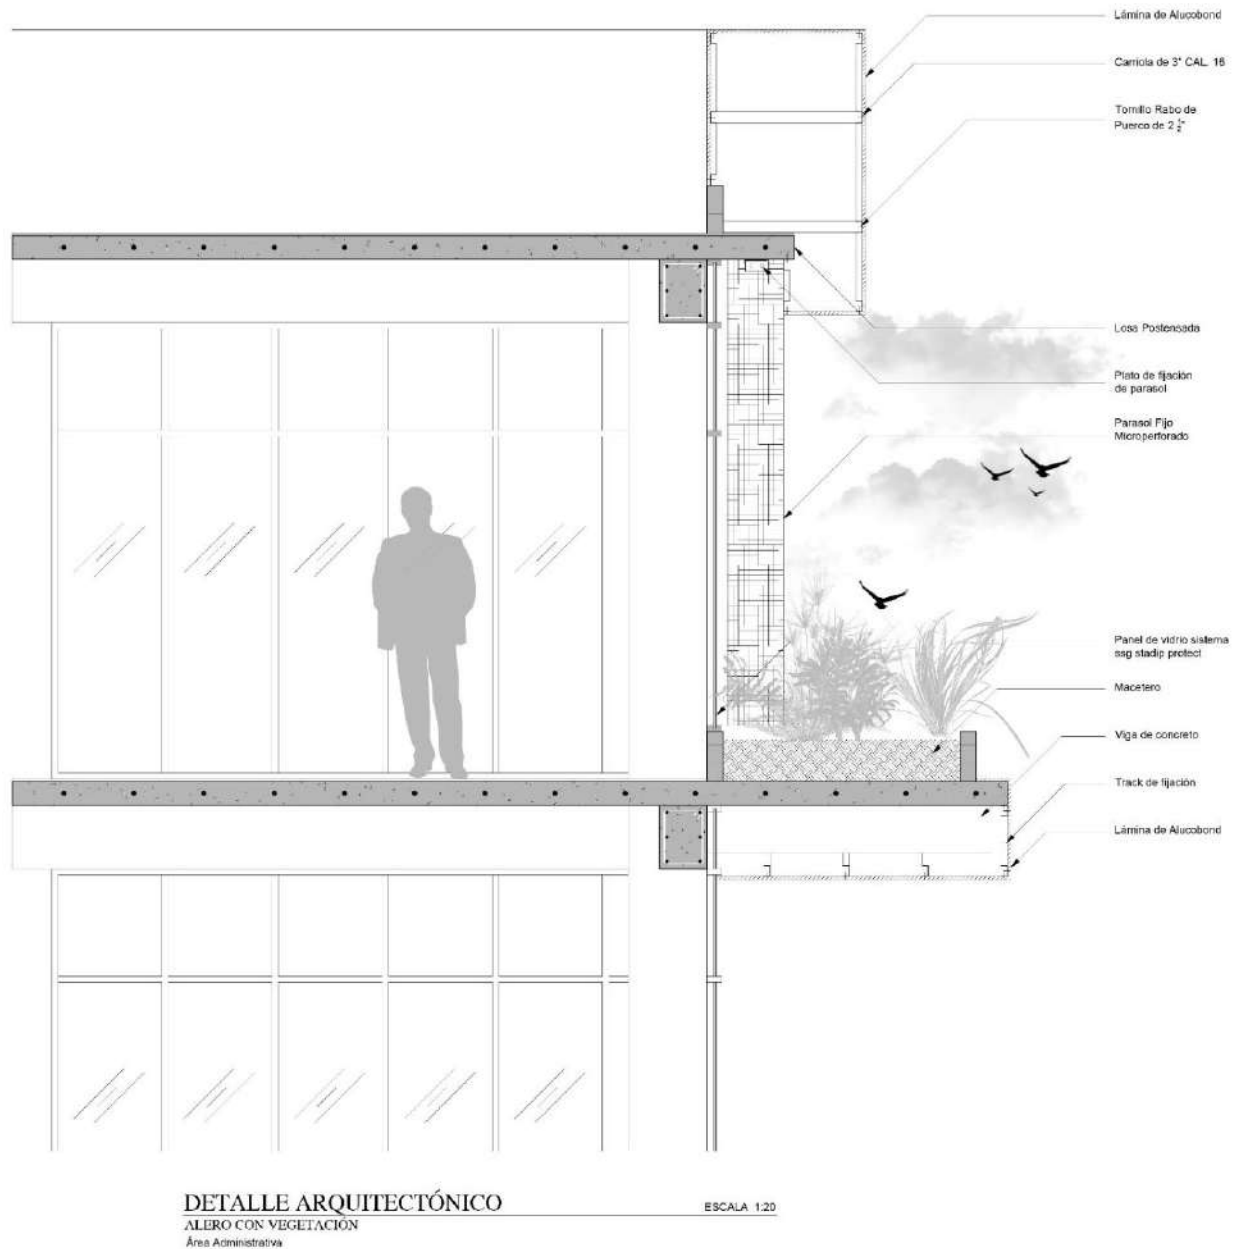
Detalle arquitectónico alero de zona administrativa. Elaboración propia
